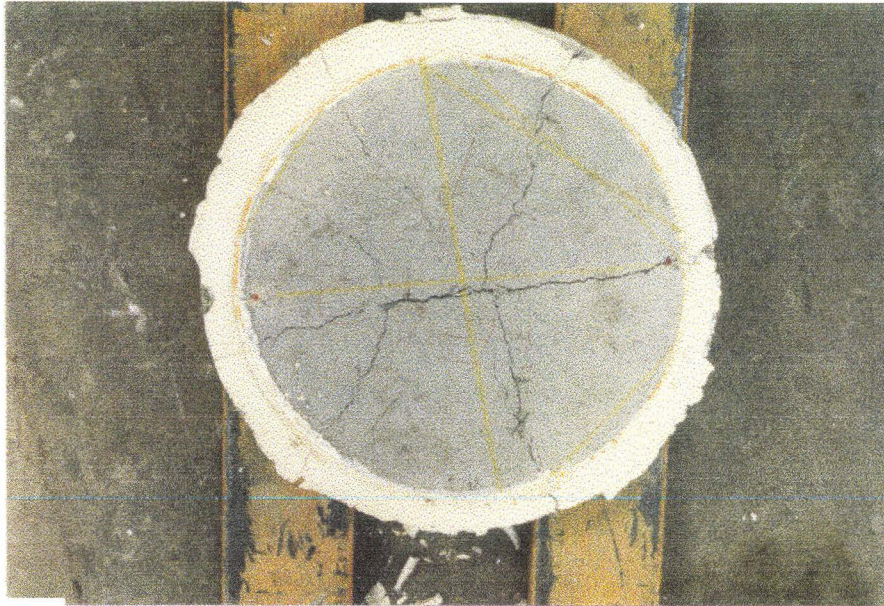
Fissuration multiple de la dalle circulaire $\text{Ø}60 \times 10 \text{ cm}$
